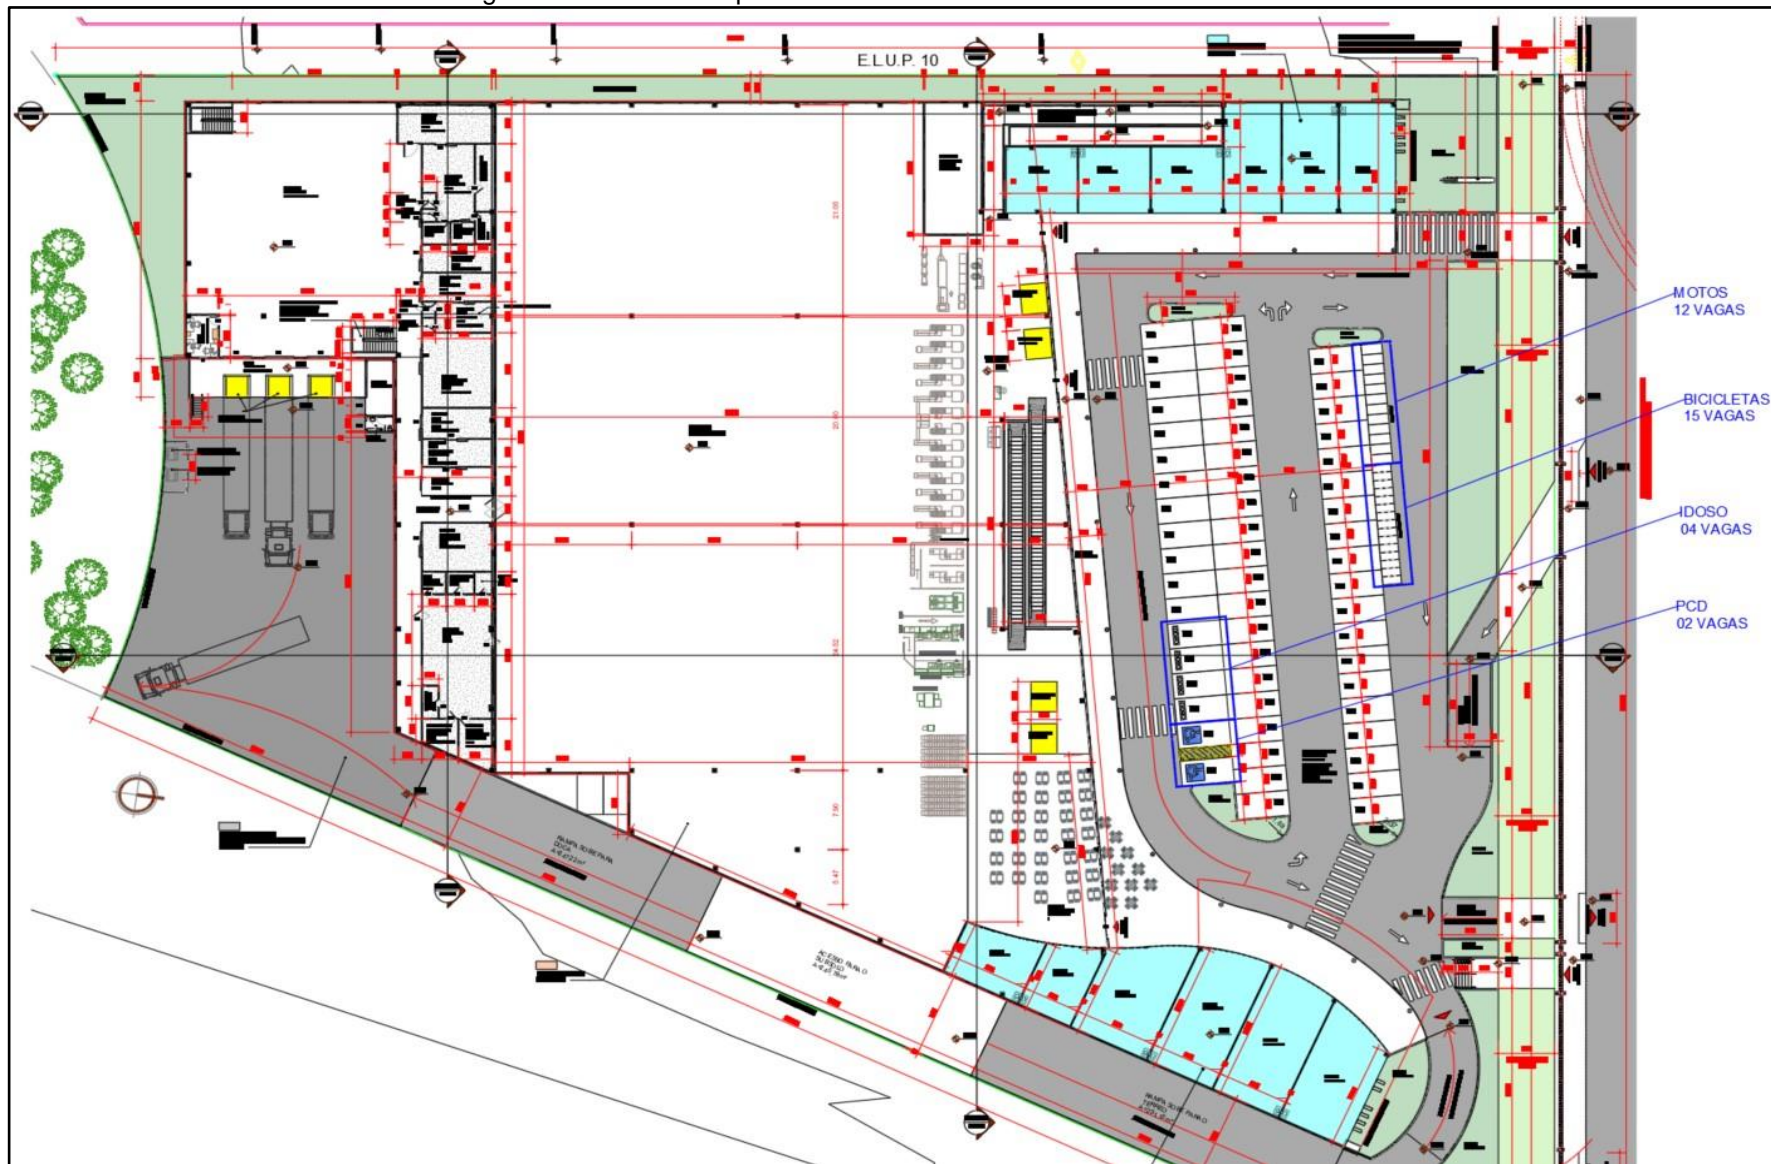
Planta baixa pavimento térreo - estacionamento.
